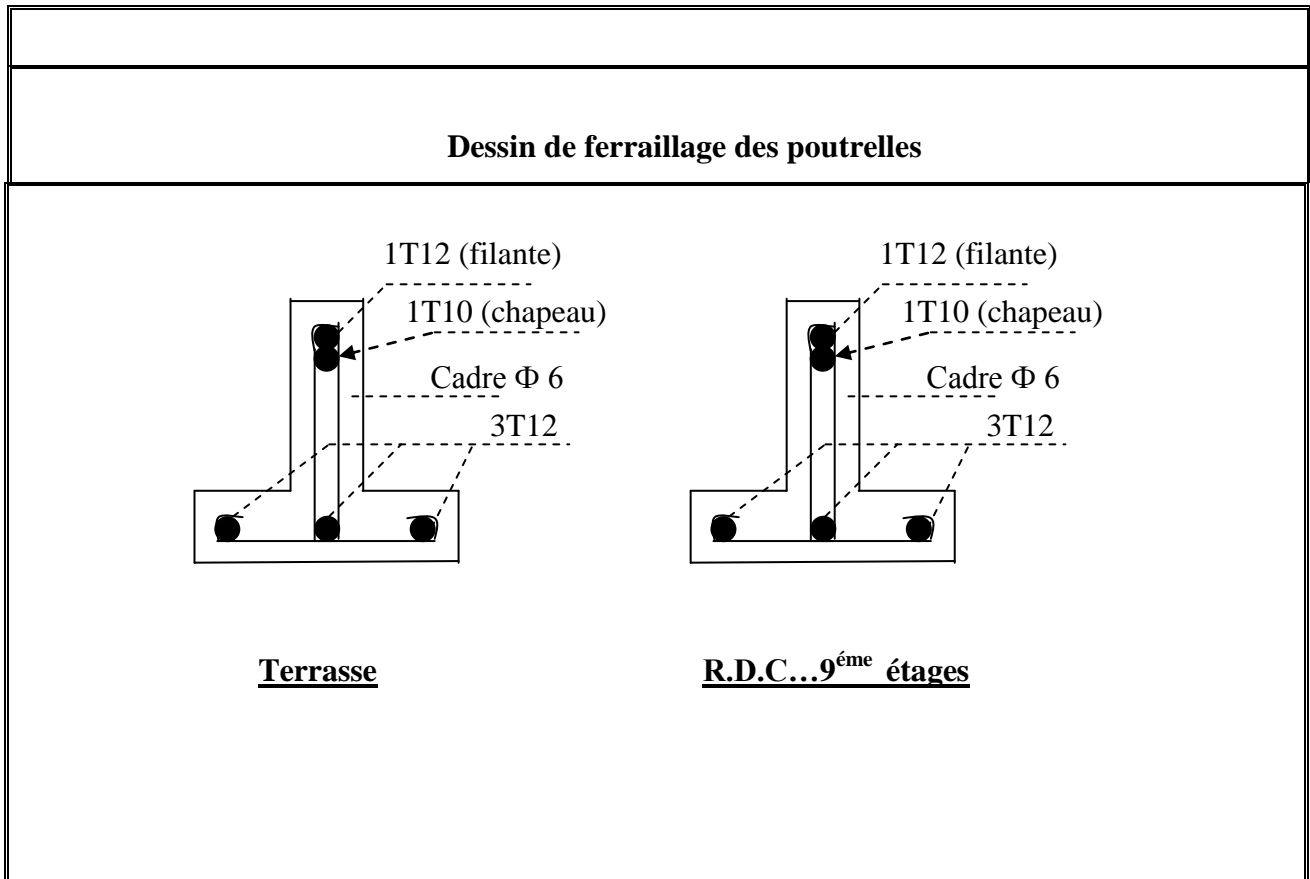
Dessin de ferrailage des poutrelles.
